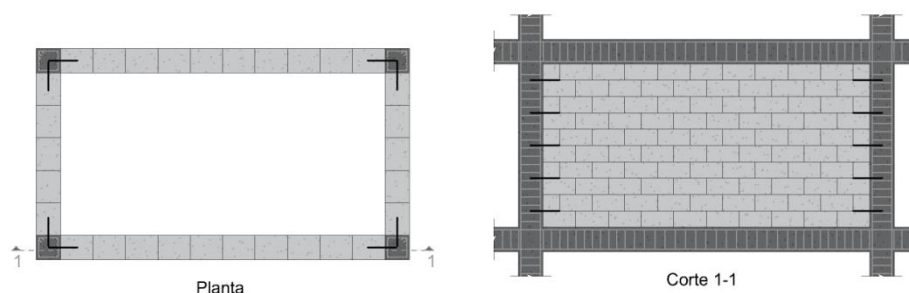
Planta e corte com esquema de ligadores (a linha preta mais acentuada) a fazer a ligação entre o pórtico de betão armado e a alvenaria
